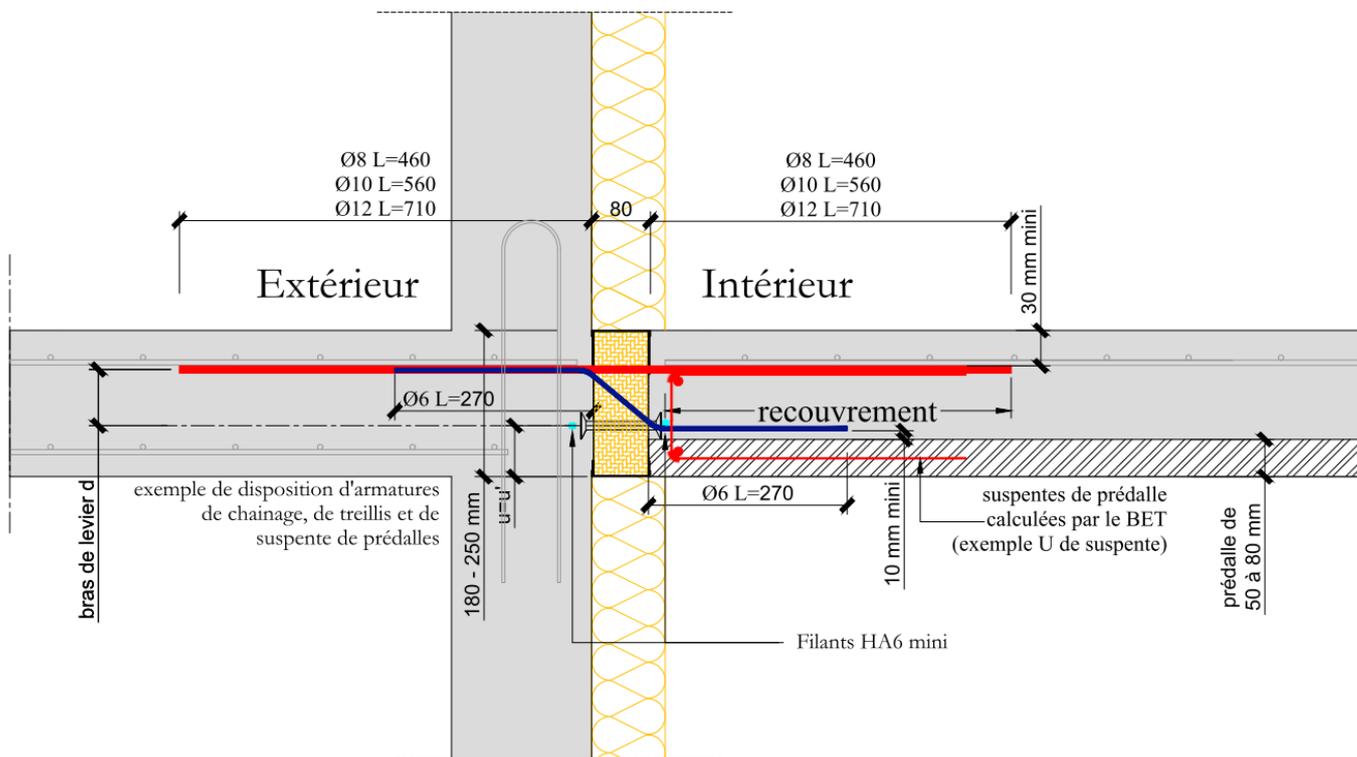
Application avec prédalles BA ou précontraintes uniquement côté dalle intérieure, prédalle intérieure contre le rupteur
